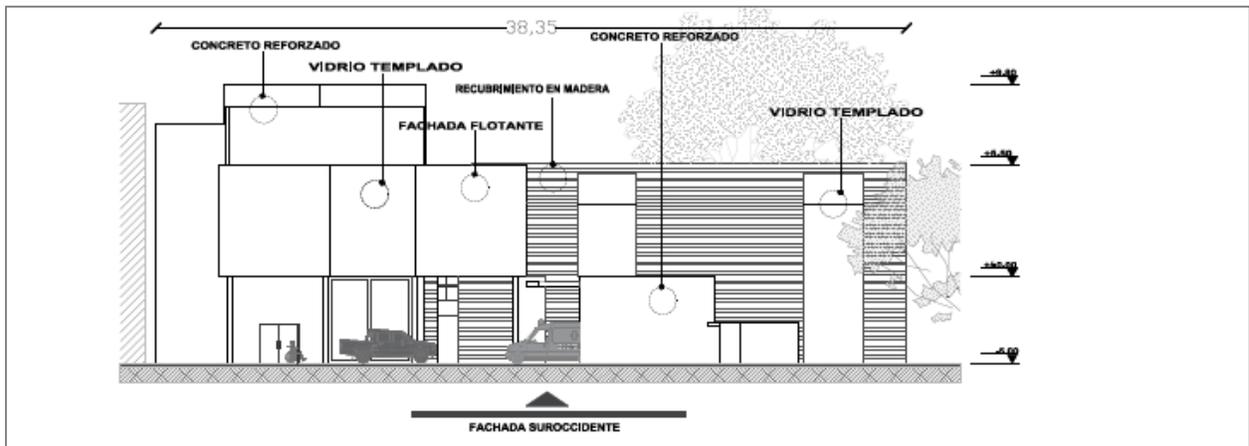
Fachada Suroccidente Edificio 2 (Rubiano, 2020)
